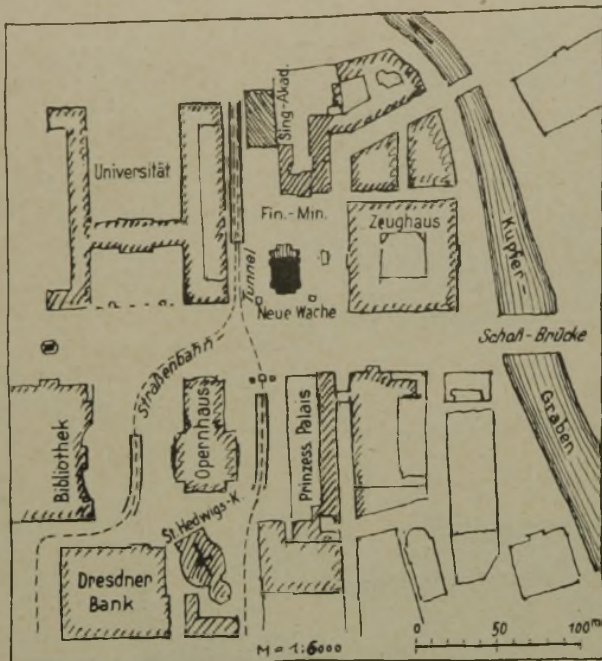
Lageplan der „Neuen Wache“ zu Berlin.
